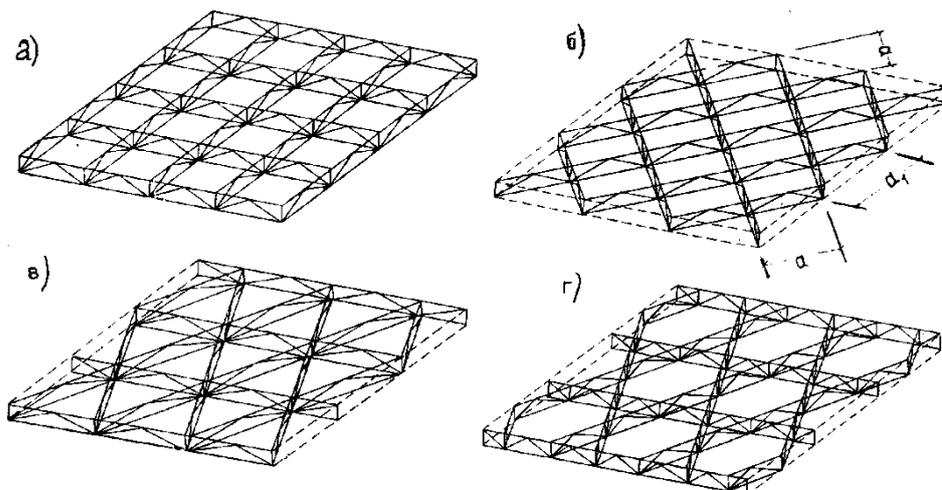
Схема покрытий из вертикальных перекрестных ферм:
